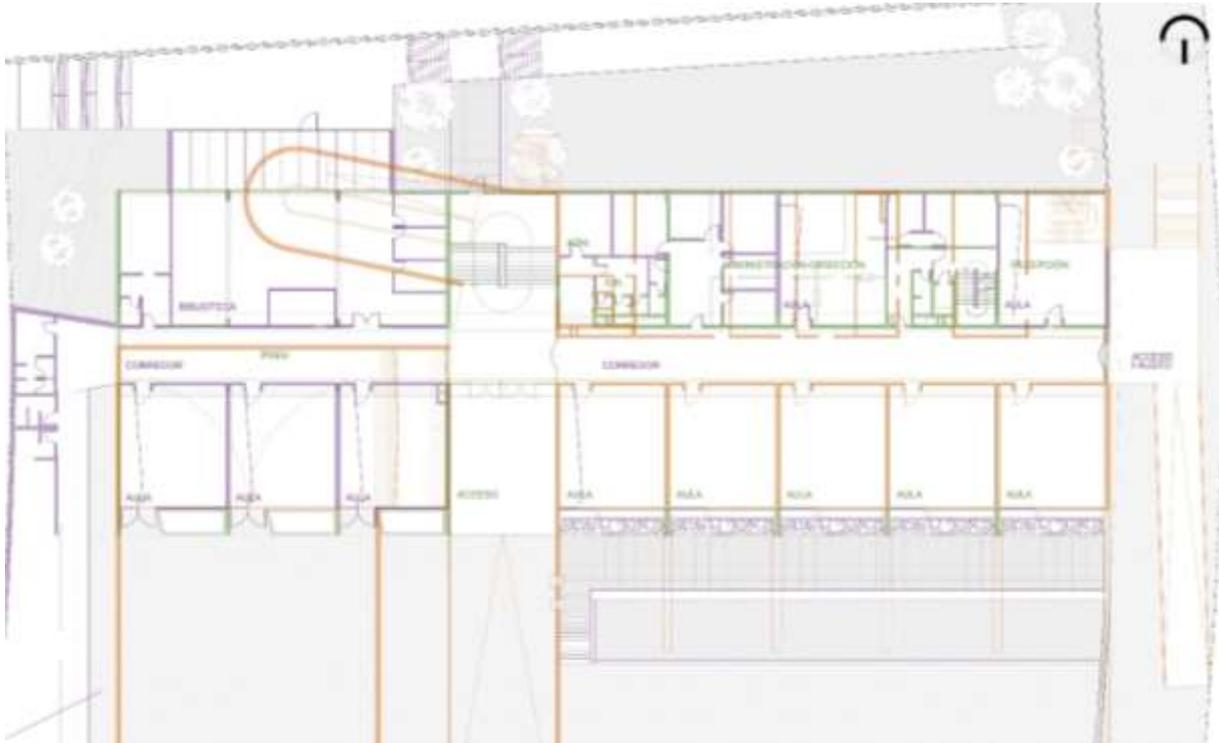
/ Superposición de Versiones. Planta Baja N+25.79 / 2024 A. Pereda
